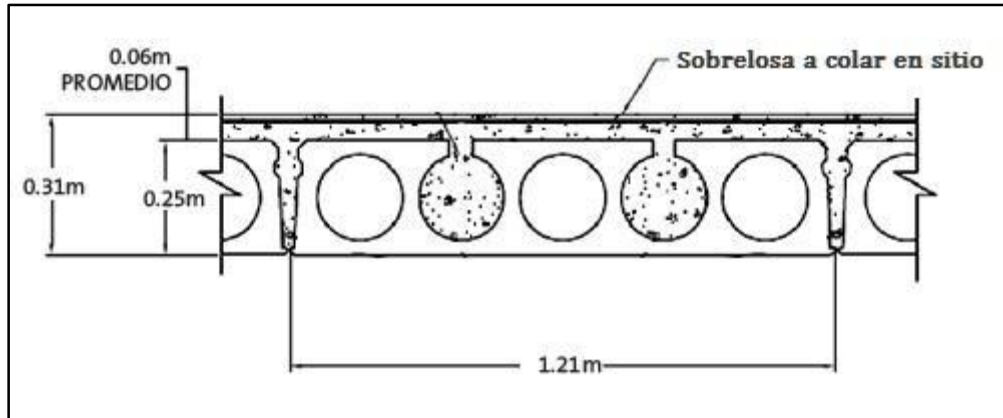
Esquema del sistema de losa alveolar (Losa-lex) con sobre losa chorreada en sitio.
